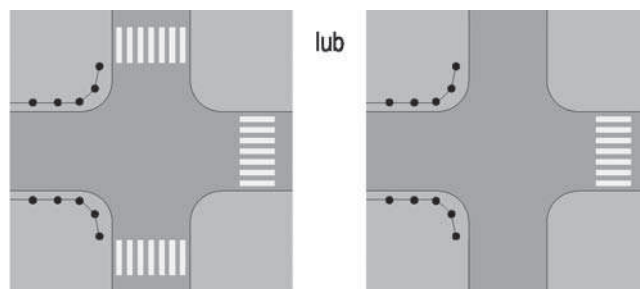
Sposób wyznaczenia przejścia dla pieszych przez powierzchnię wyłączoną z ruchu
